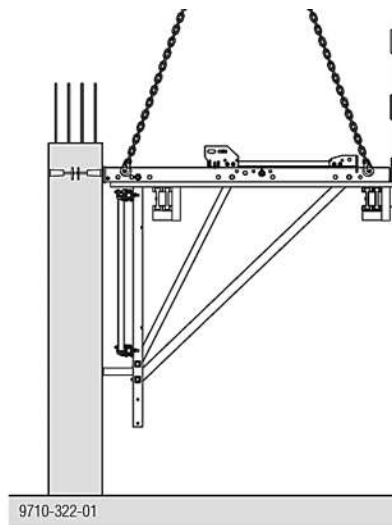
Colocación de la plataforma intermedia de trabajo
